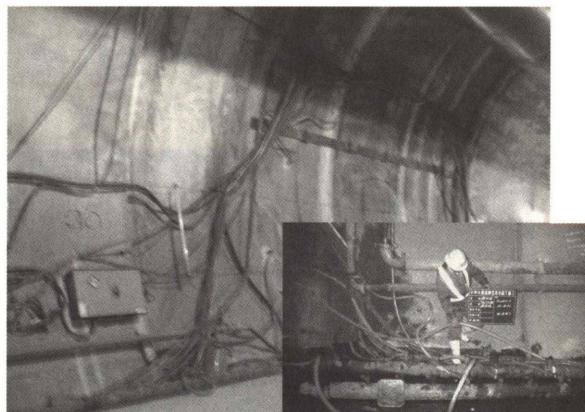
No. 2 器材坑 ウェルポイント設置状況
